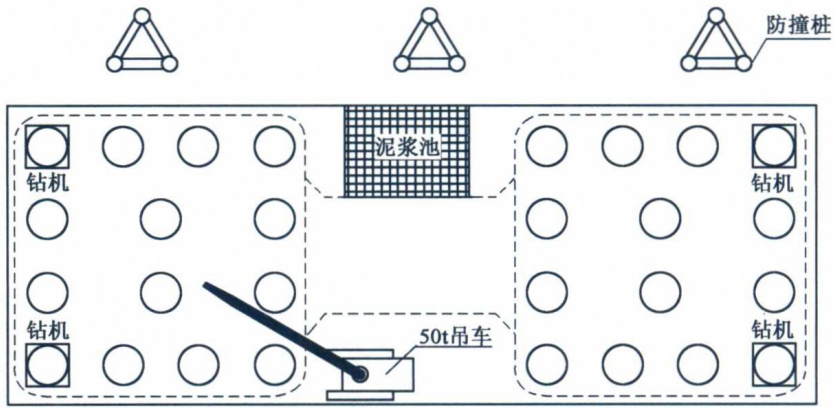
东海大桥主桥斜拉桥主墩施工平台平面布置
